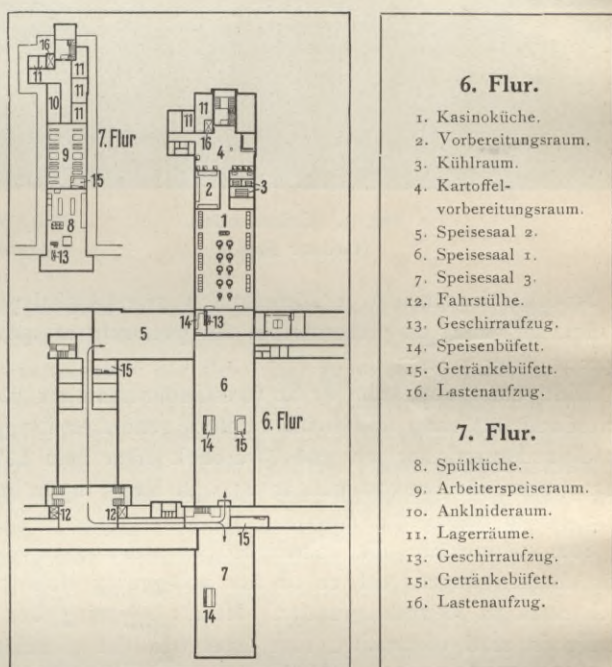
Plan öfver kök och matsalar. (Grundriss der Küchen- und Speiseräume.)
